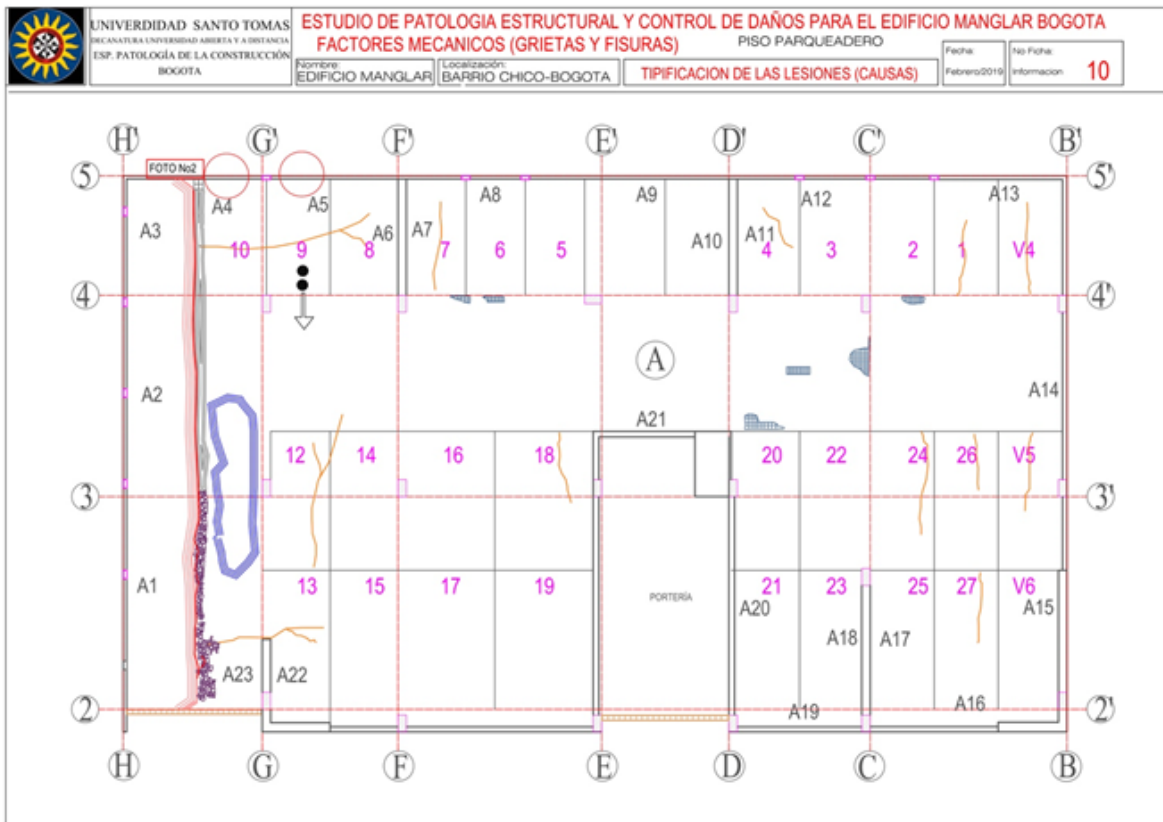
Planta Registro de Daños Vista Inferior Placa. Fuente: Elaboración propia
